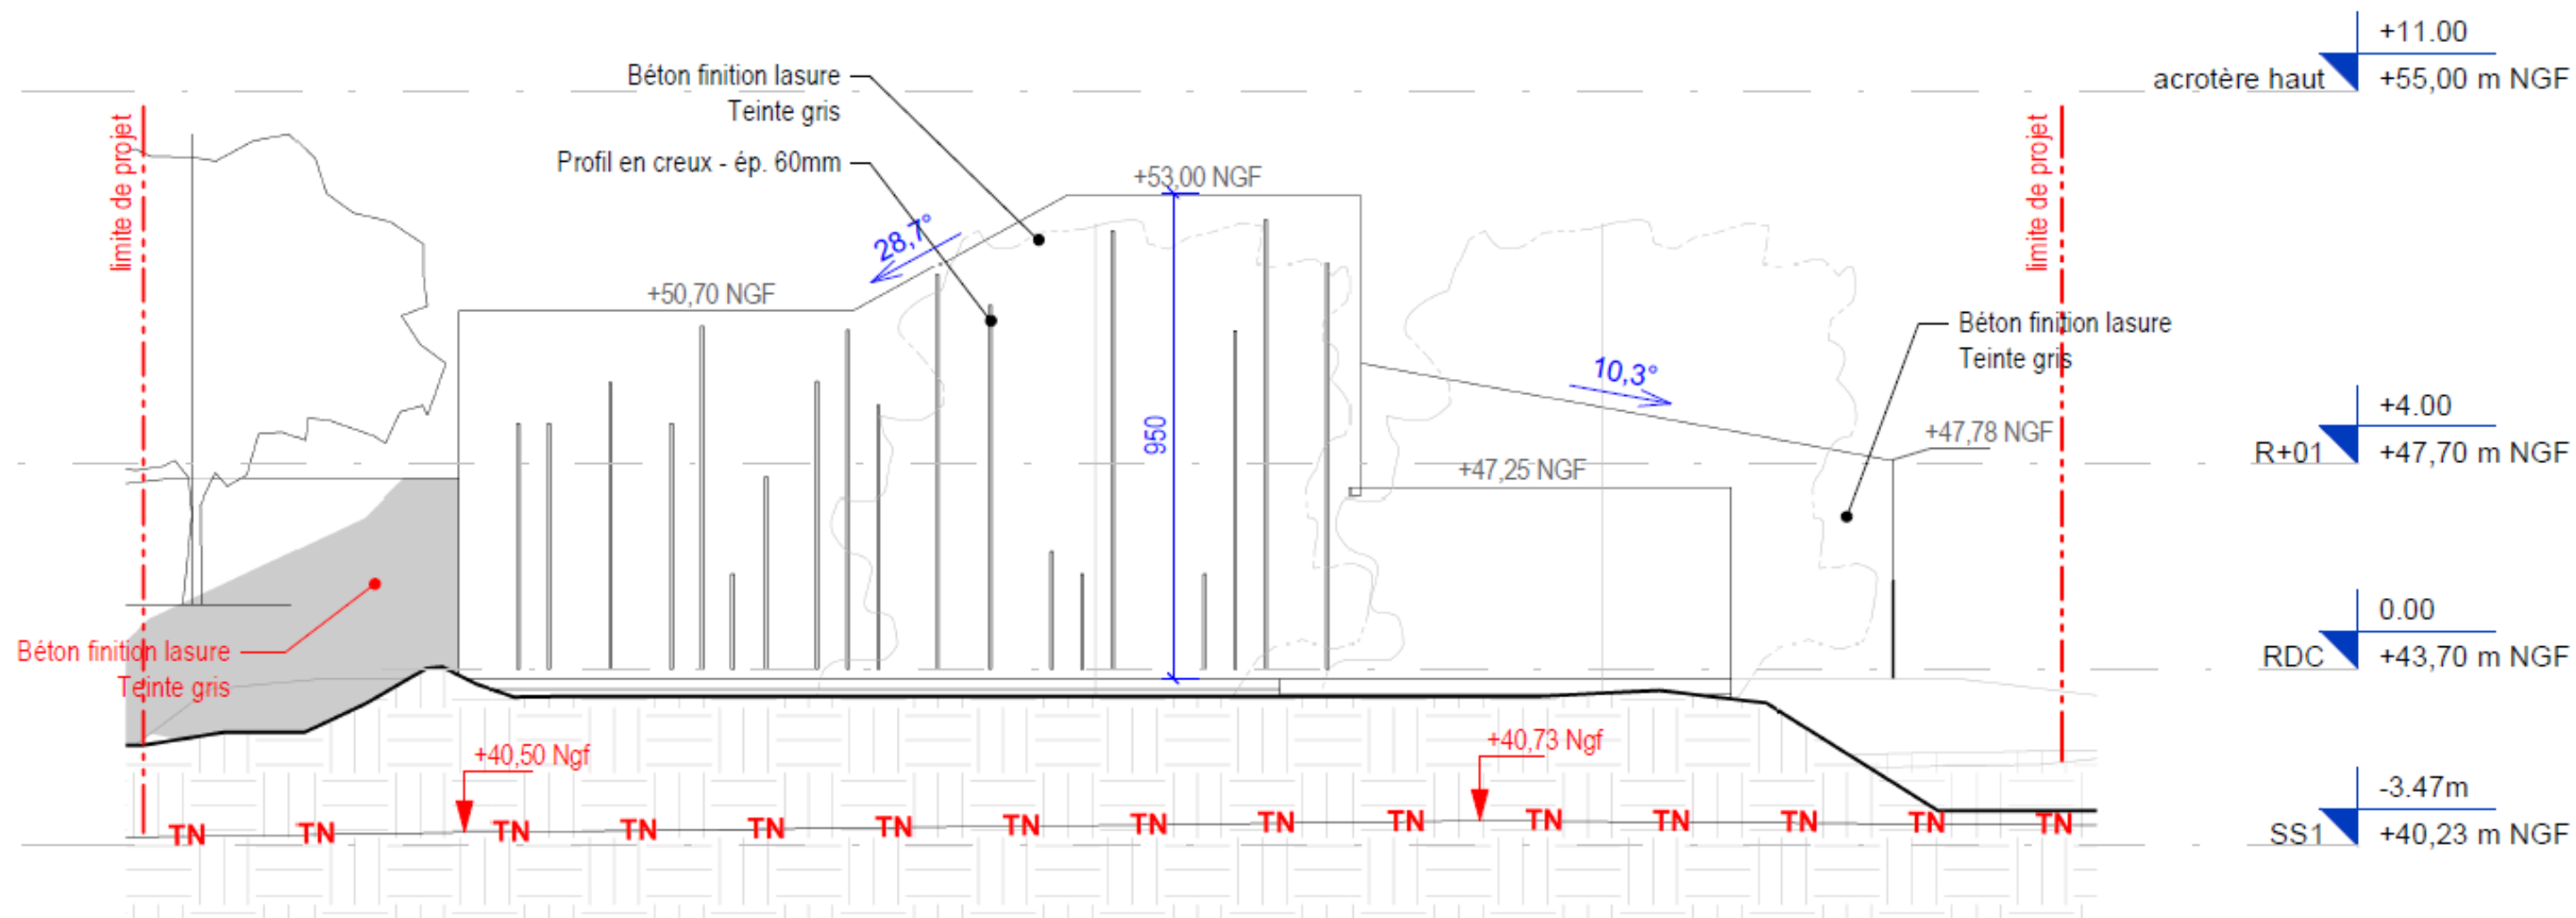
Plan de façade Est du Waterjump. Source : PCM2
